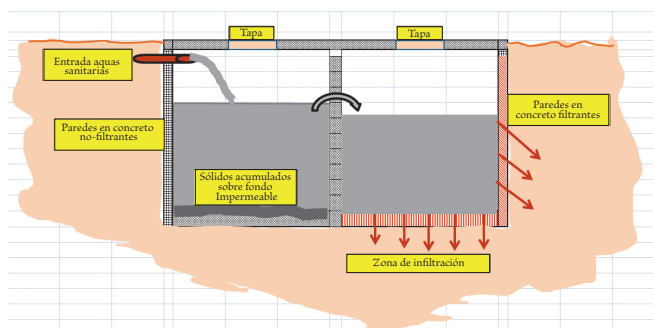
Pozo séptico de dos cámaras interconectadas, fondo sellado en la primera cámara con fondo y paredes filtrantes en la segunda cámara.
